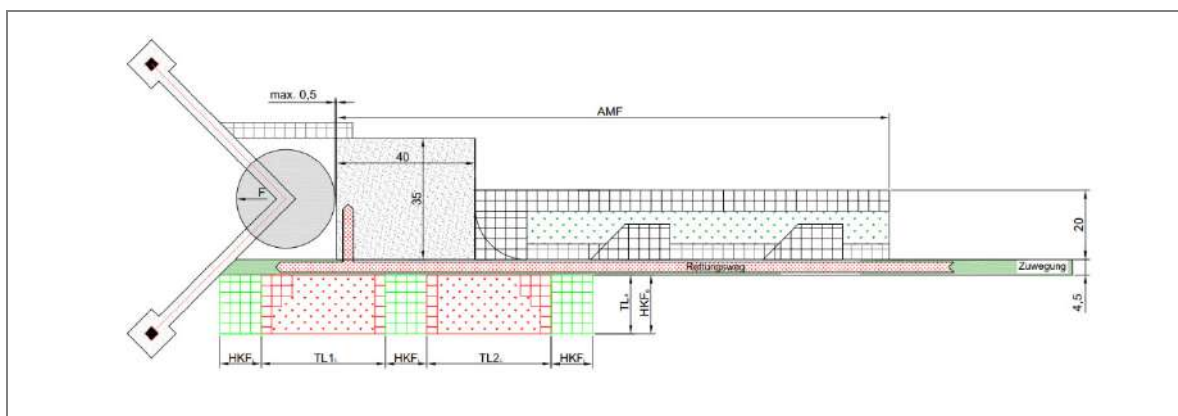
Positionierung der Turmlagerflächen (rot) inkl. der Hilfskranflächen (grün) neben der KSF (Variante 1)
